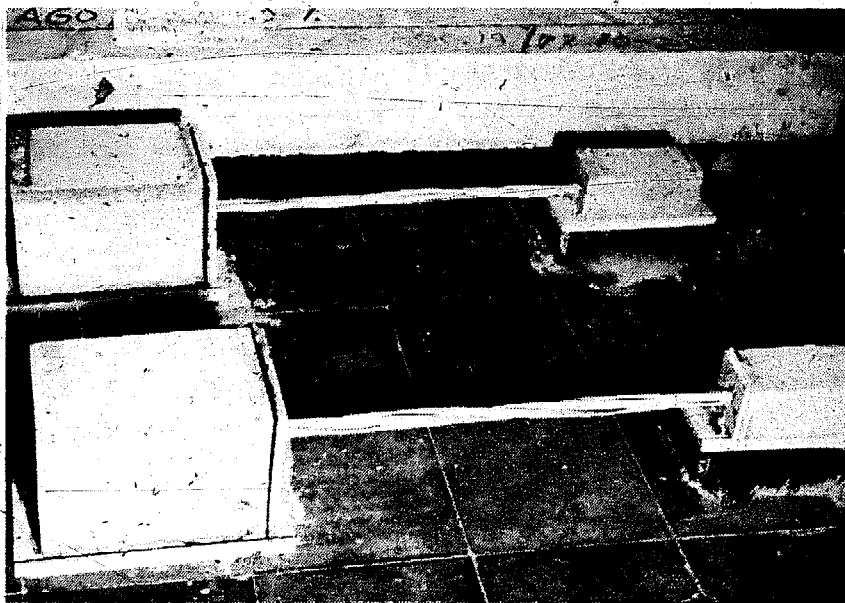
Ensayo de adherencia de los cables en el concreto.
